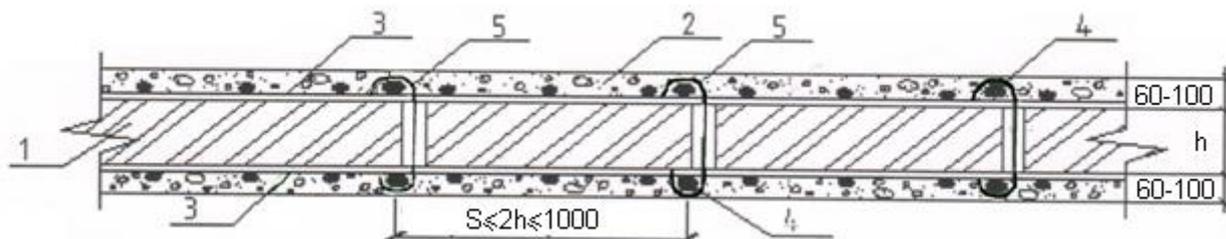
Схема усиления кирпичной стены железобетонной набетонкой:
